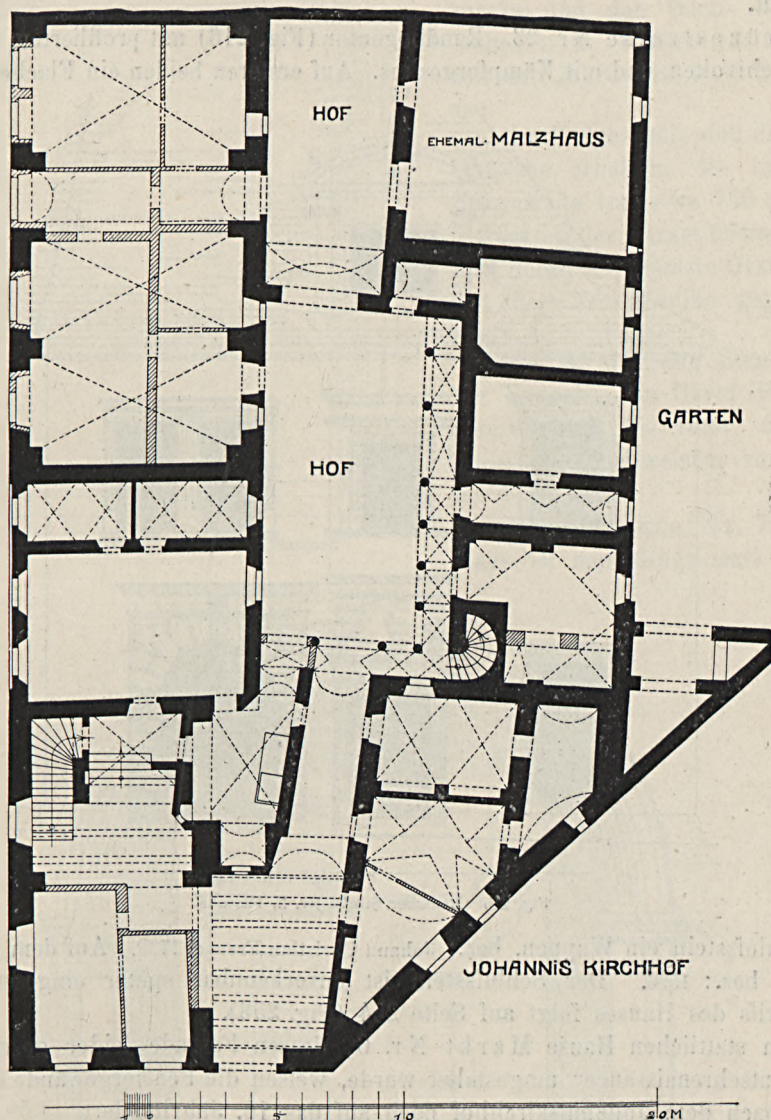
Bautzner Straße Nr. 2, Grundriß.
